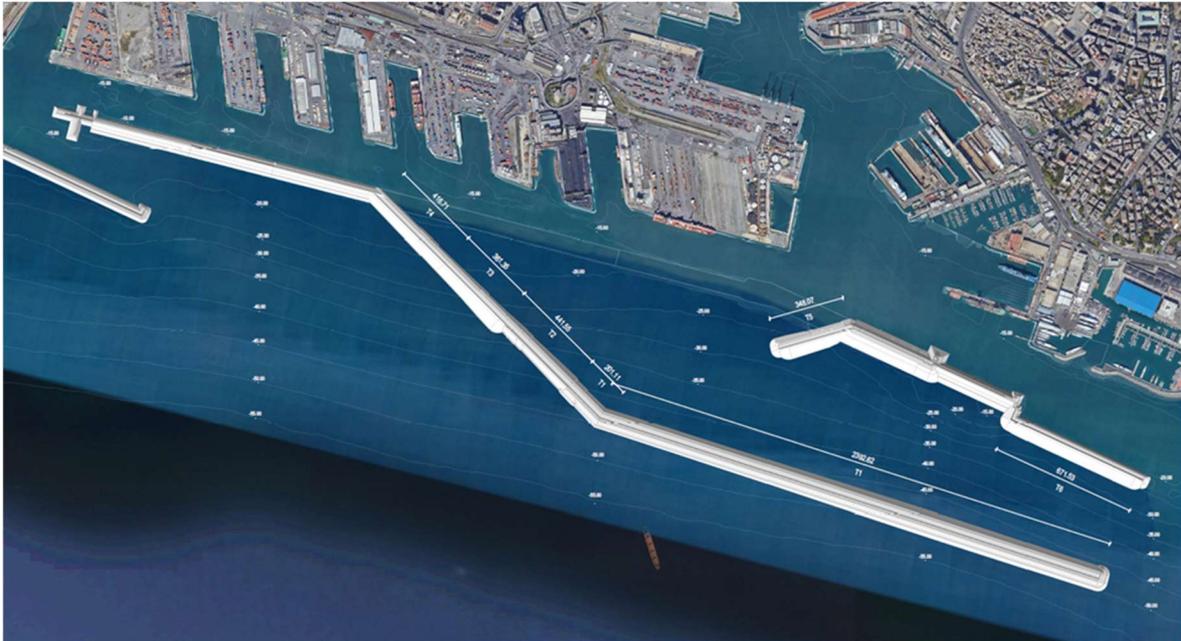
Planimetria della configurazione di progetto della nuova diga.
